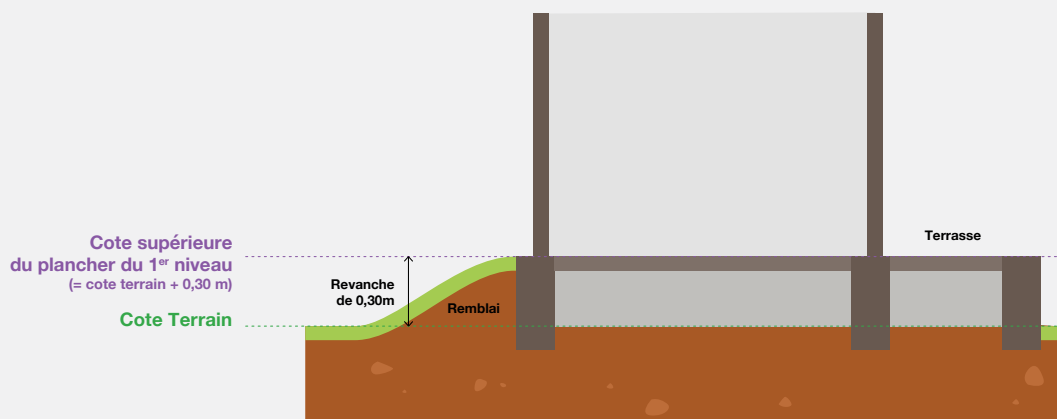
Cote du plancher du 1^{er} niveau = cote du terrain + 0,30 m avec remblai.
